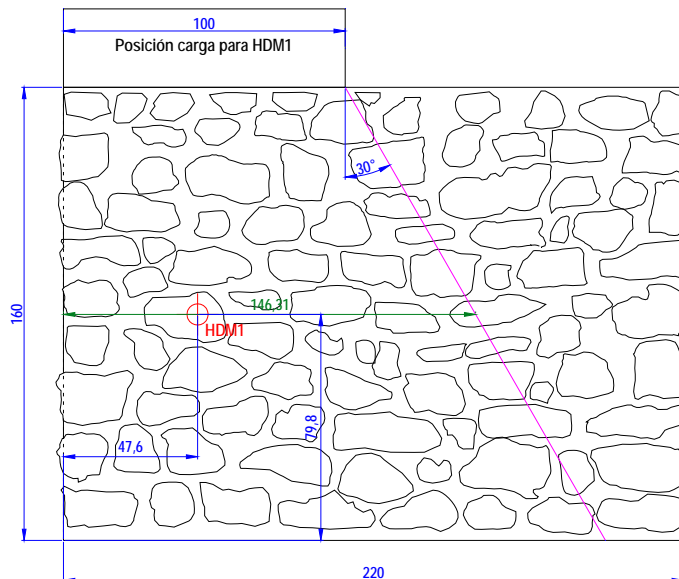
Alzado del muro de mampostería con la localización del HDM1. El espesor del muro son 31 cm. Las cotas referidas son cm.
